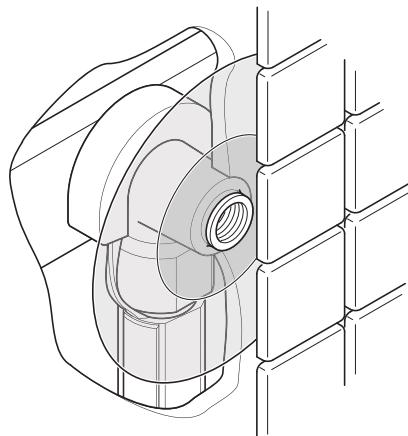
Монтаж с использованием уплотнительной шайбы Geberit для соединительных элементов
